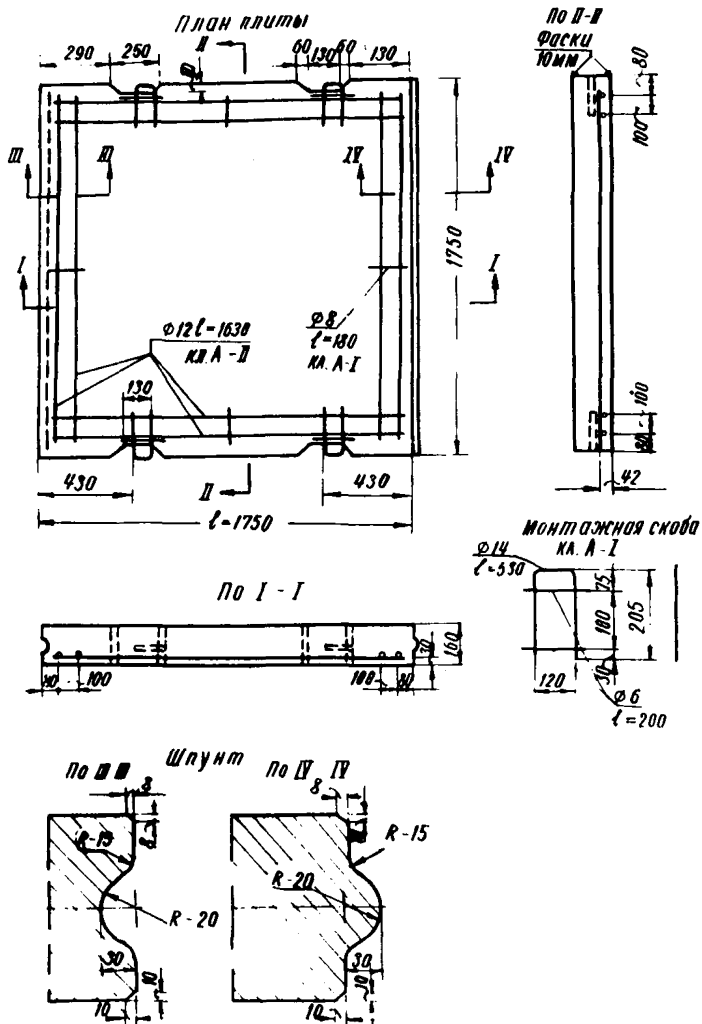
Дорожная плита 1,75x1,75м с армированием по контуру. Расход арматуры 4,8 кг/м²
